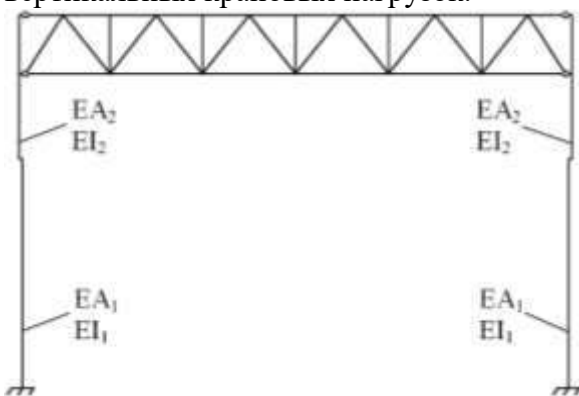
Расчетная схема поперечной рамы с ригелем в виде фермы, жестко сопряженной с колоннами.
